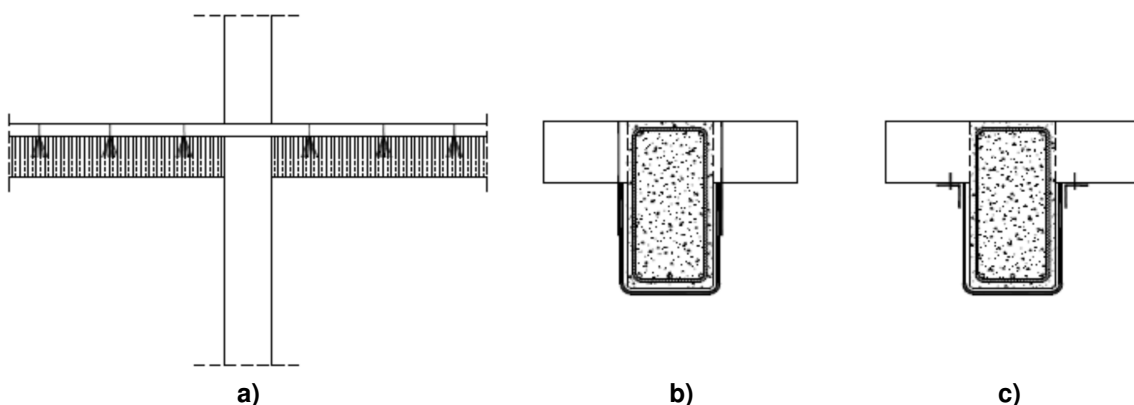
Reforzamiento a cortante continuo de una viga de hormigón armado interna con materiales compuestos CFRP o SRP, con dos tipologías de anclaje: a) Vista longitudinal; b) Conectores de fibra en abanico; c) elementos angulares metálicos en la parte inferior de la placa.
